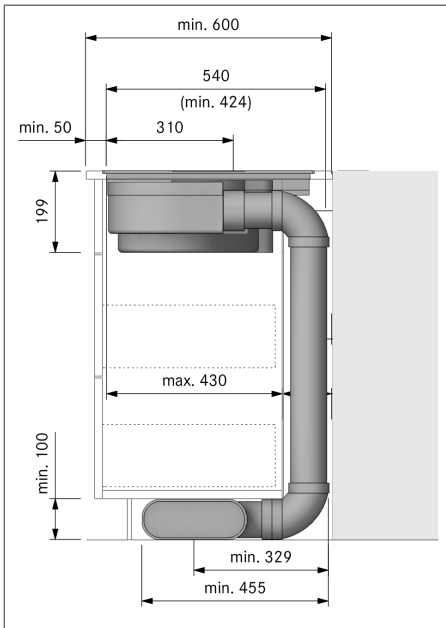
Monteringsdimensjoner ved uttrekking, benkeplatedybde 600 mm
